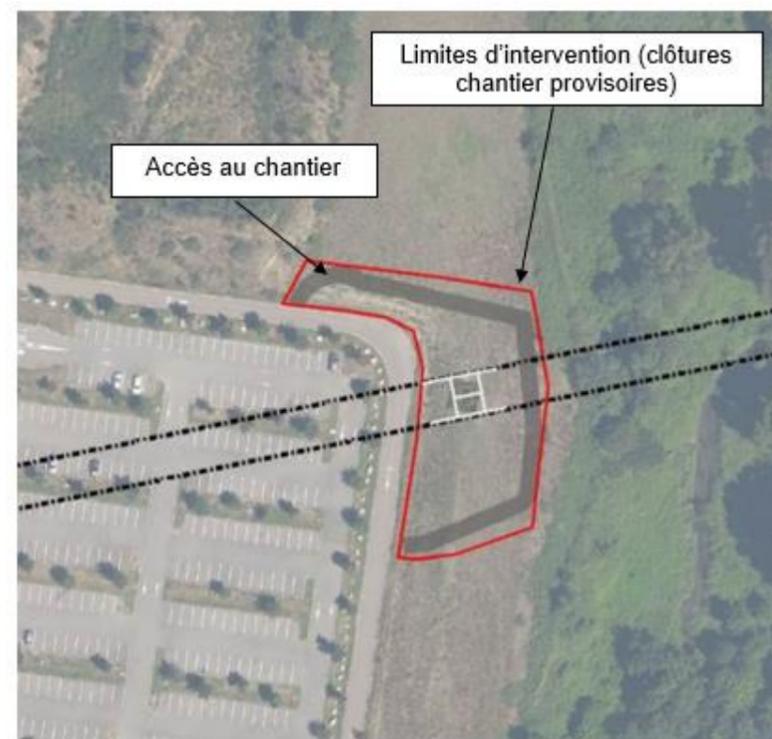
Plan de localisation des travaux de mise en place du P1 (source : Groupement POMA, 2017)
